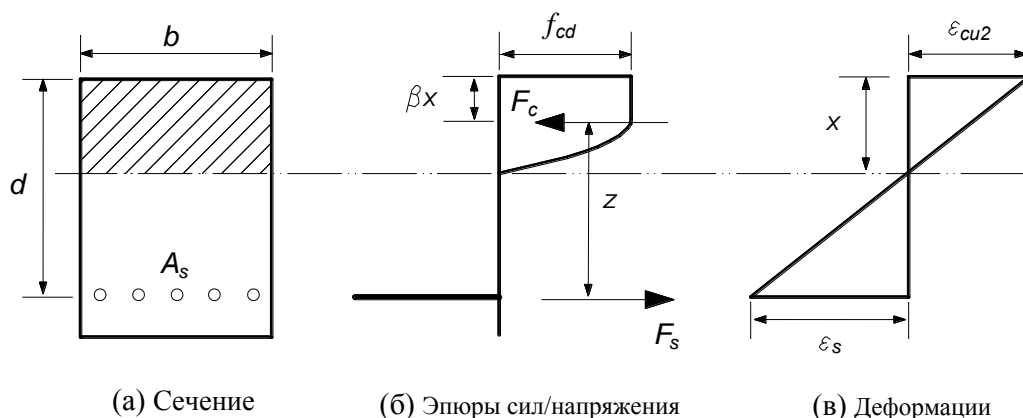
Балка прямоугольного сечения с одиночной арматурой (параболически-прямоугольная эпюра напряжений в бетоне при разрушении)
